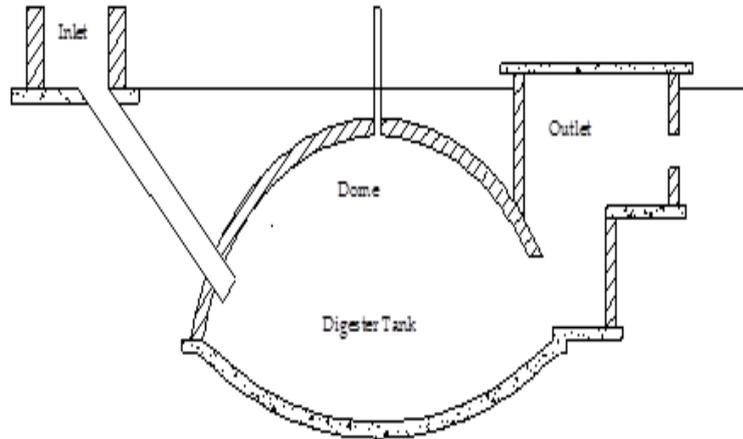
GGC Nepal Concrete Model Biogas Plant
